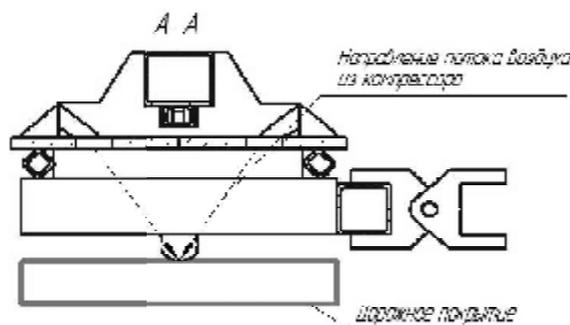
Направление потока воздуха из компрессора перед сушкой инфракрасными излучением
